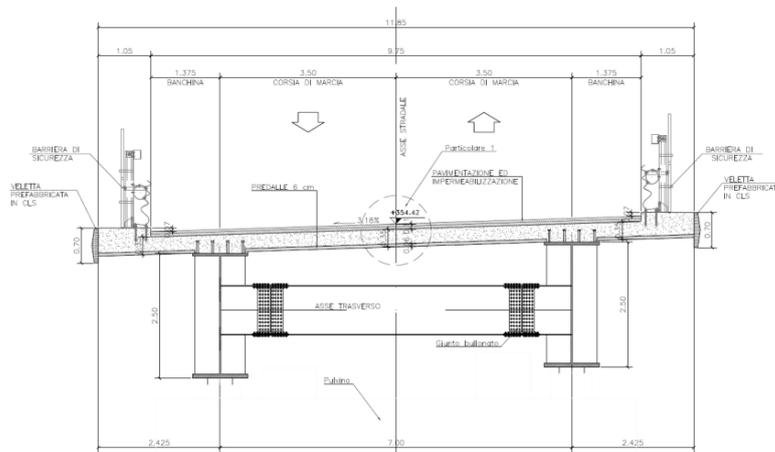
Sezione Trasversale dell'impalcato del Viadotto Marroggia 1.
